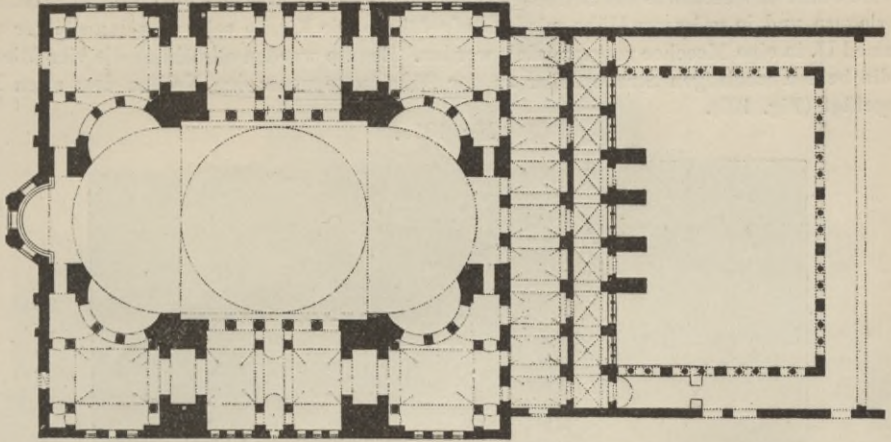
Grundriss der Sophienkirche zu Konstantinopel (nach Salzenberg).
